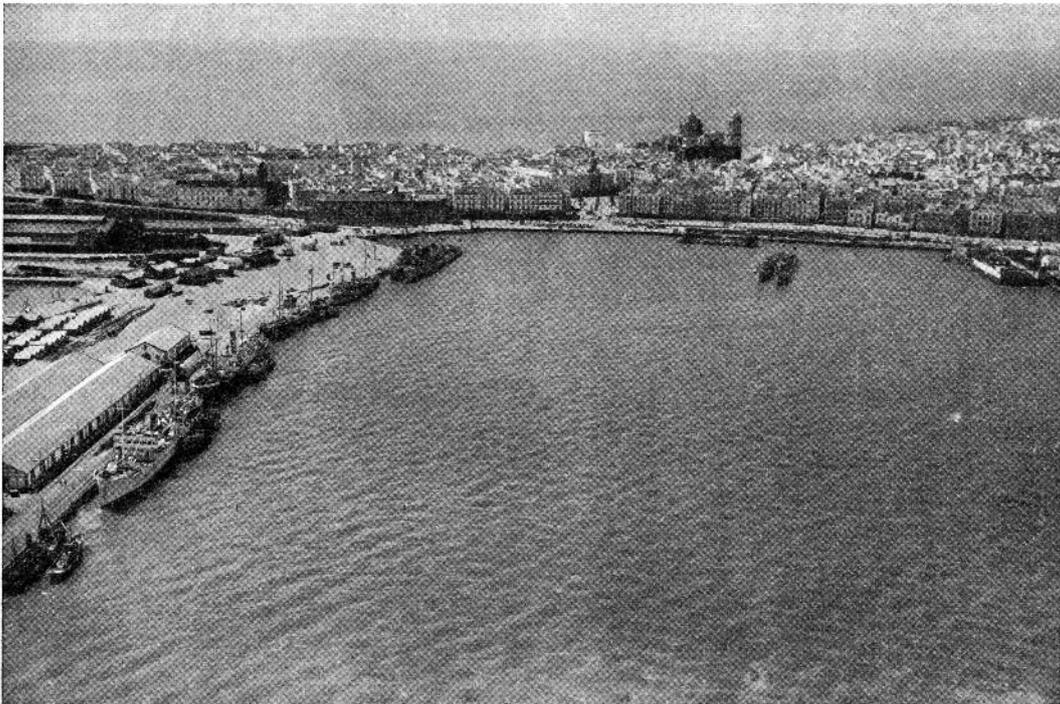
<sup>a</sup> Vista de la dársena de Moret. A la derecha, en el extremo Sur del muelle del Depósito Franco, el dique flotante y las instalaciones para la construcción de cajones de hormigón armado, y abarloado al muelle, frente a la Catedral y detrás de los dos destructores amarrados a la boya, uno de los cajones, a flote
